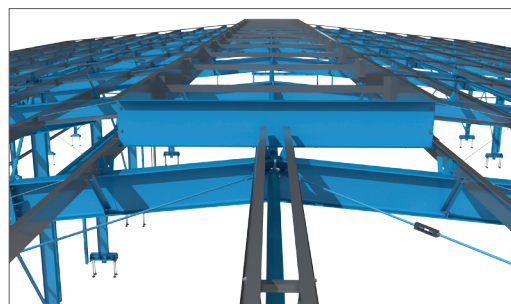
Układ konstrukcyjny świetlika równoległego do płatwi dachowych
